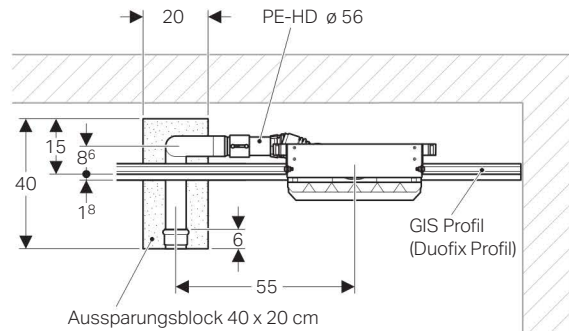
Grundriss der optimalen Einlegeposition für Geberit Wandablauf für Dusche
